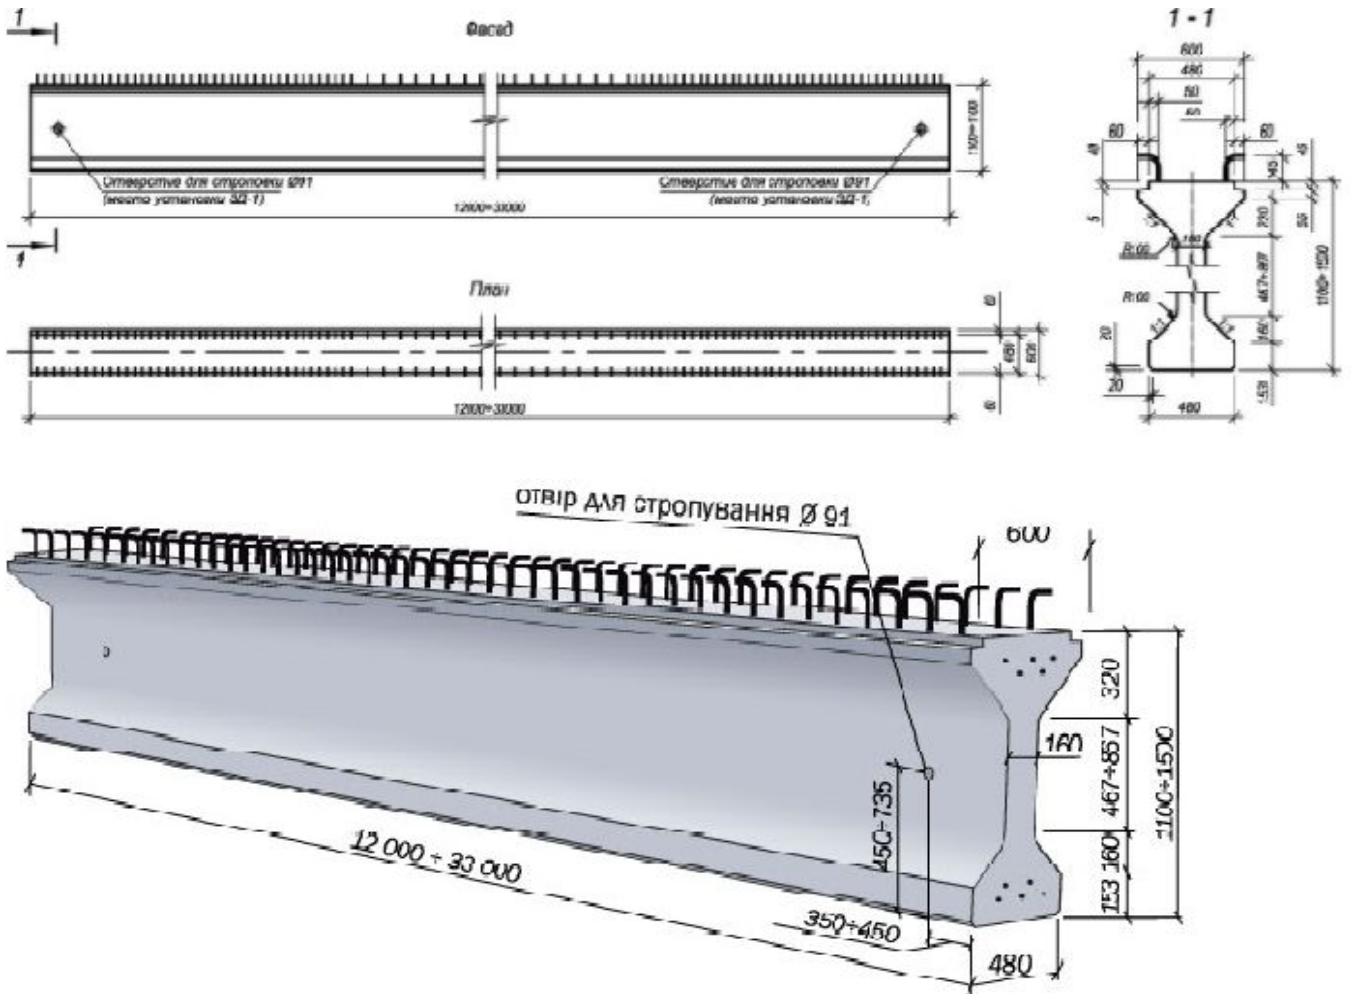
Попередньо напружена залізобетонна балка
